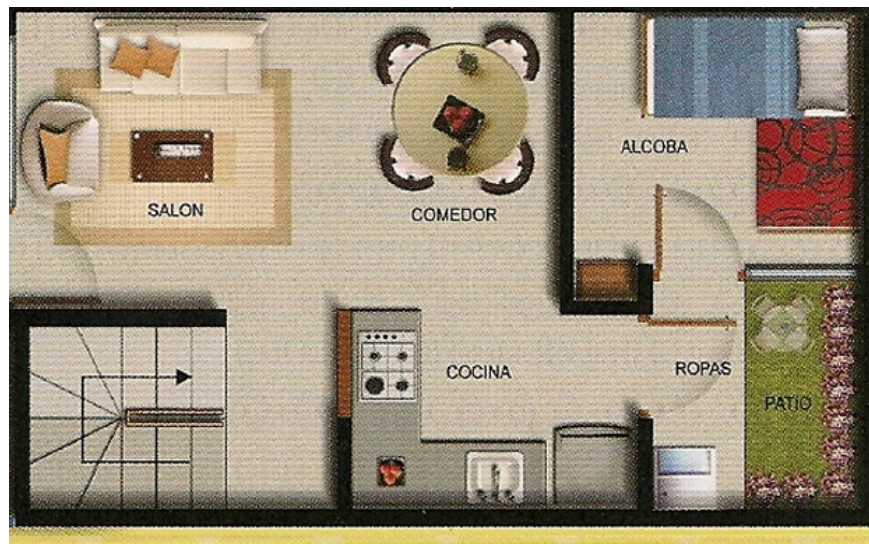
Primer piso Tomado de: Proyecto de vivienda; Plano de distribución. Paseo del puente II. Constructora Marval.
